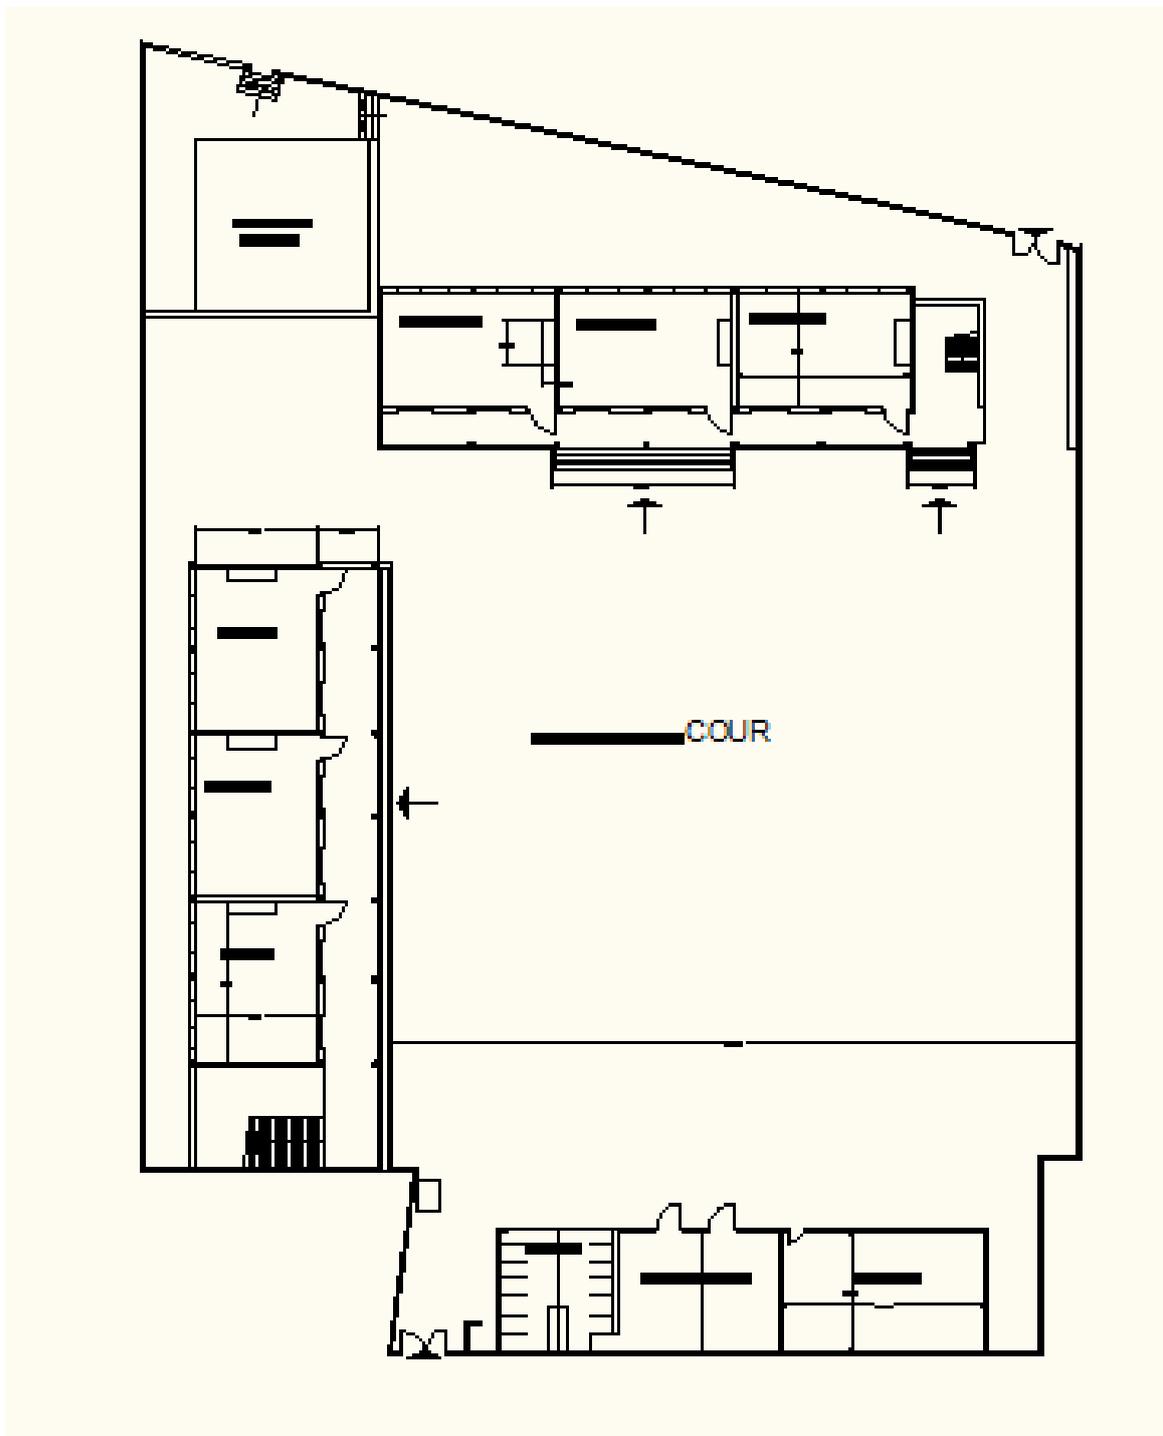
Plan rez-de-chaussée de l'école Ibn Baytar
